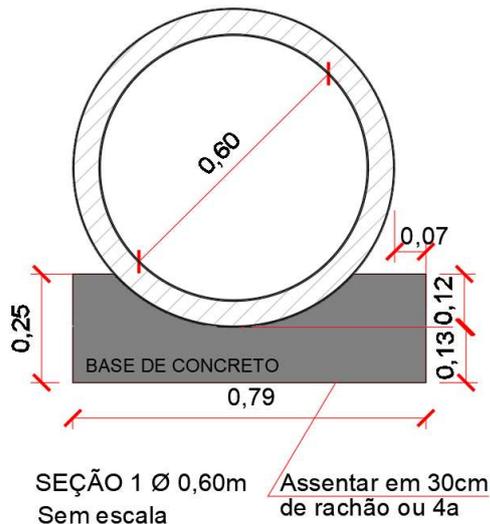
Detalhe –Galerias Pluviais. Fonte: WEGG PONTA GROSSA, 2017.
